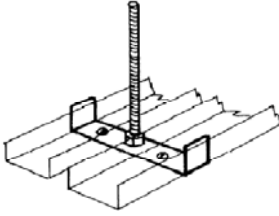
Merkezi askı tutucu montaj şekilleri
